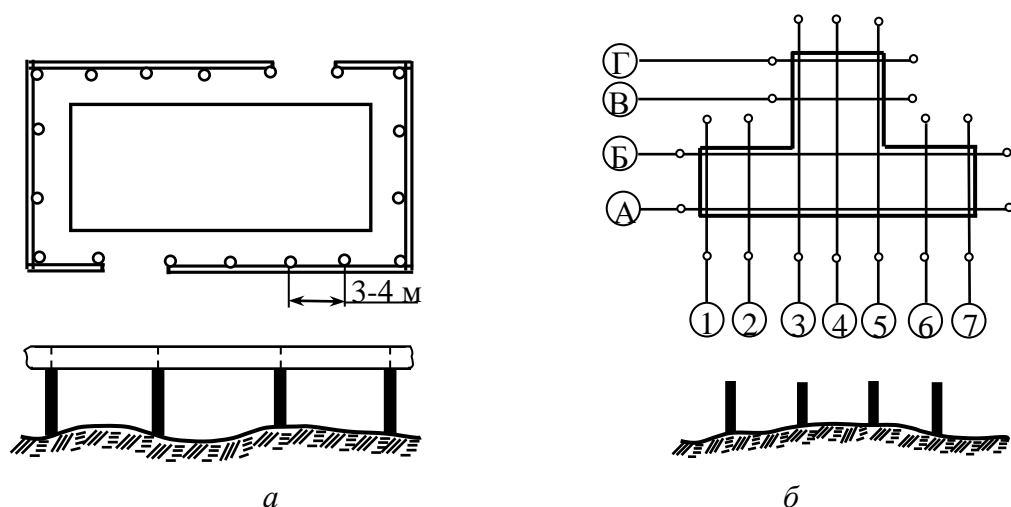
Схема побудови обноски: а – суцільна; б – створна
